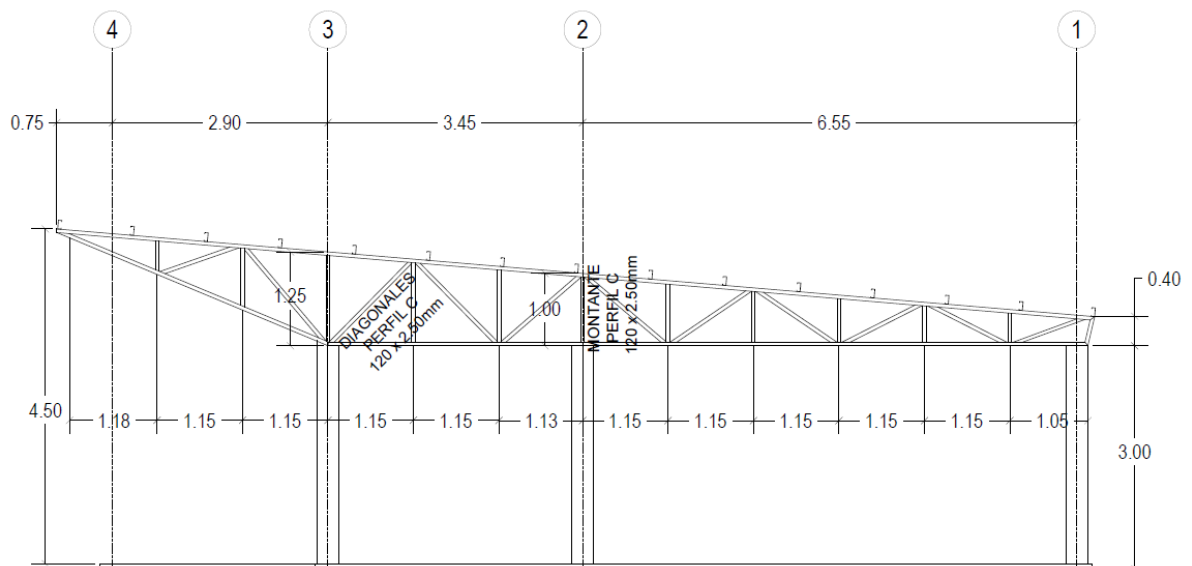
DETALLE DE VIGA RETICULADA | DIAGONALES Y MONTANTES
